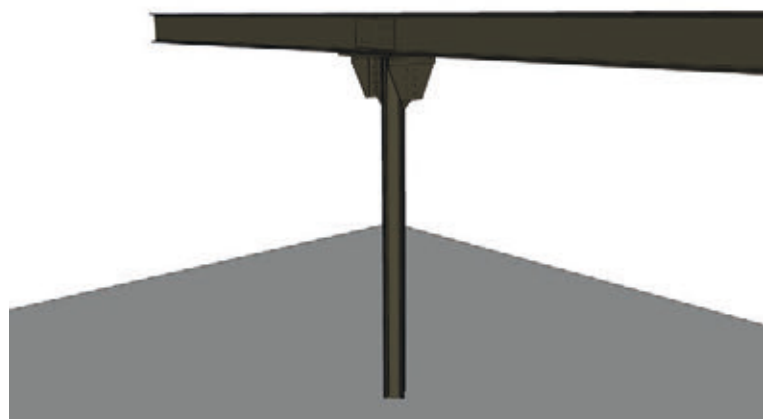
Struttura orizzontale primaria poggia su struttura in elevazione verticale
